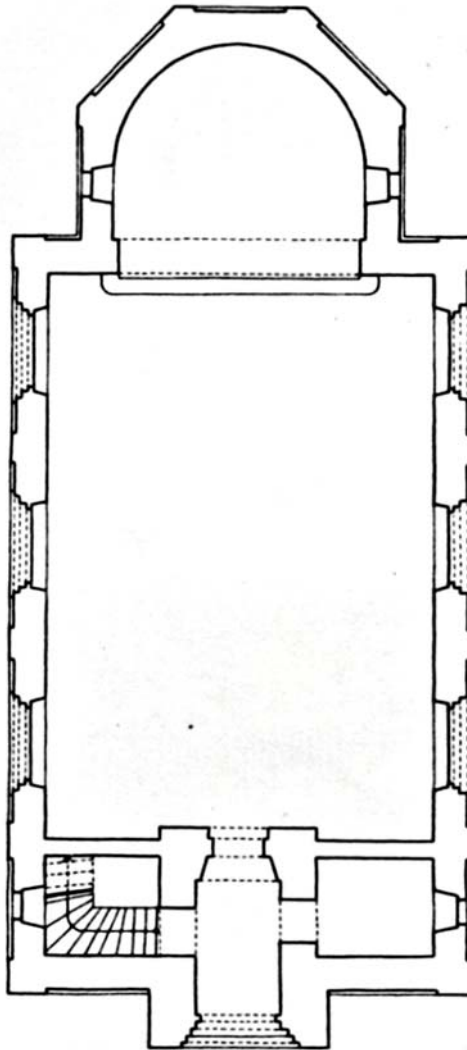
Grundriss Erdgeschoss, Zustand vor dem Umbau 1956
